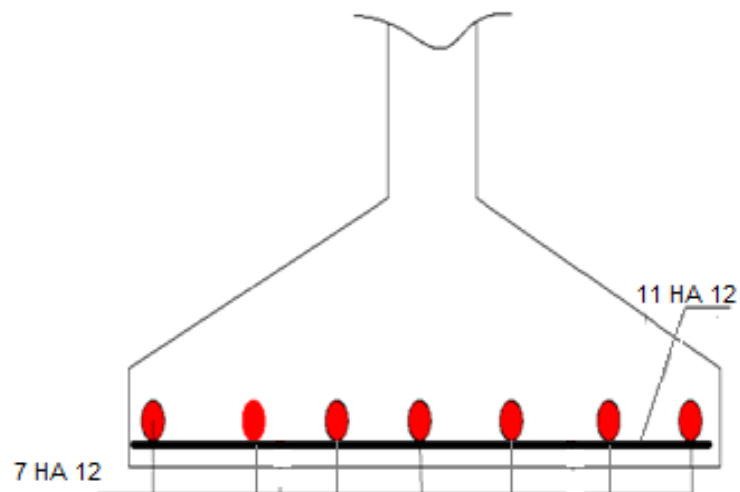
Schéma de ferrailage de la semelle jumelée
